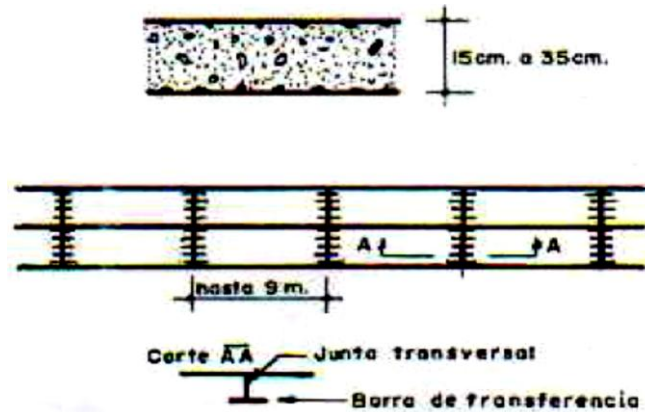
Gráfica de Pavimento Rígido con Refuerzo en las Juntas
